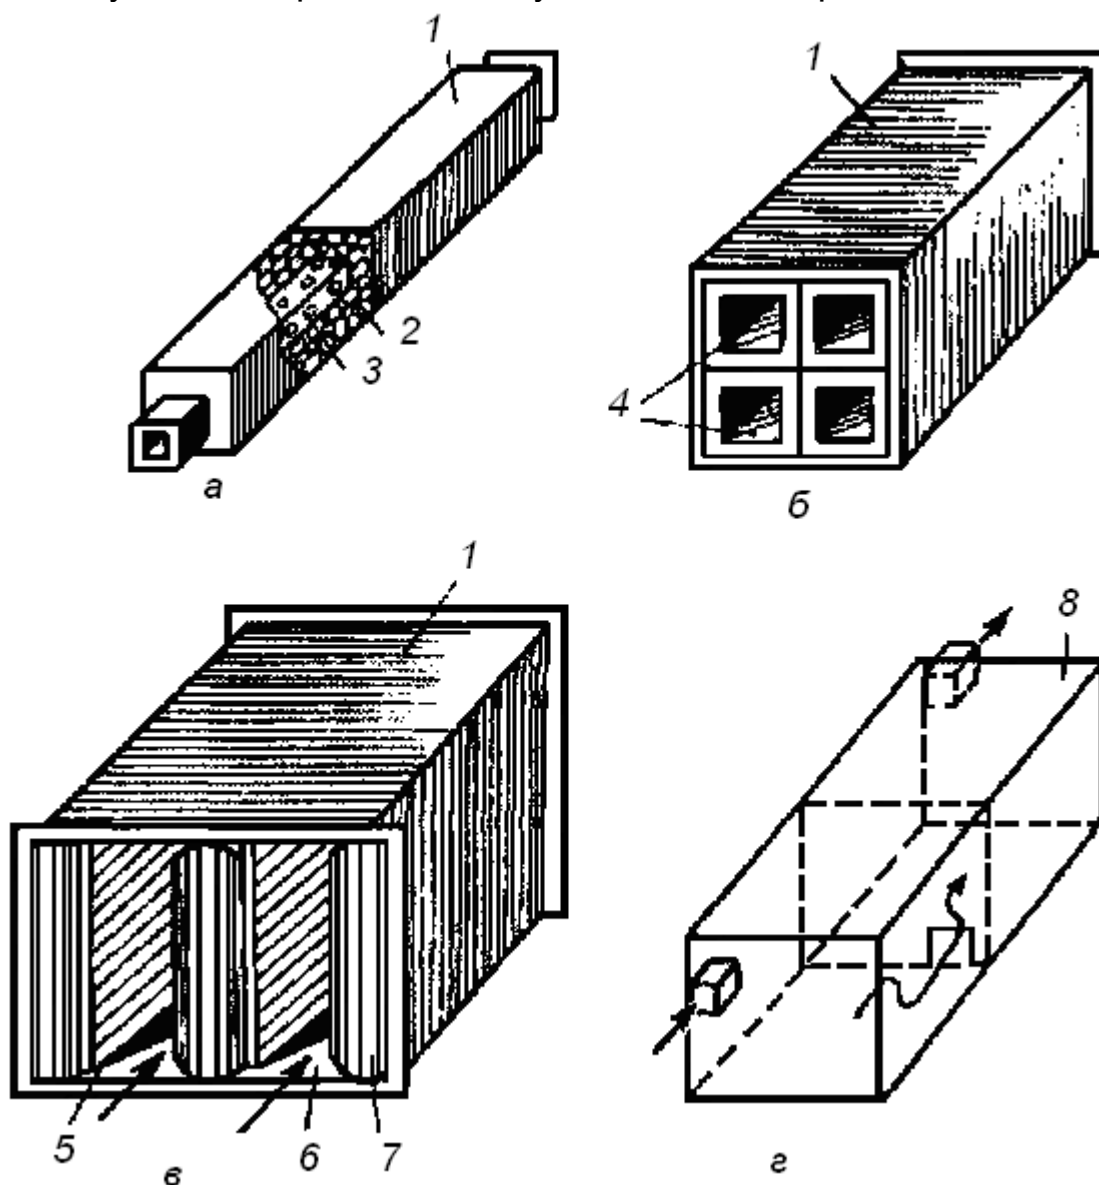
Конструкции глушителей шума: 1 – кожух; 2 – звукопоглощающий материал; 3 – воздуховод; 4 – звукопоглощающие ячейки; 5 – звукопоглощающие пластины; 6 – каналы для прохода воздуха; 7 – обтекатели; 8 – камера
